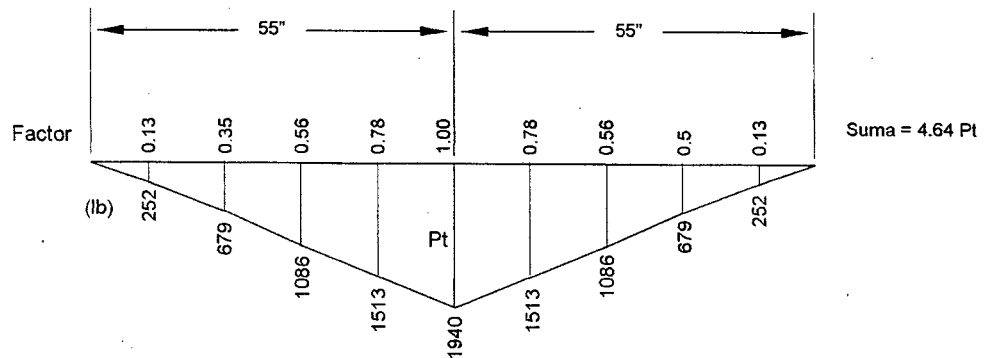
3 Fuerzas en las pasajuntas debido a la carga B.
